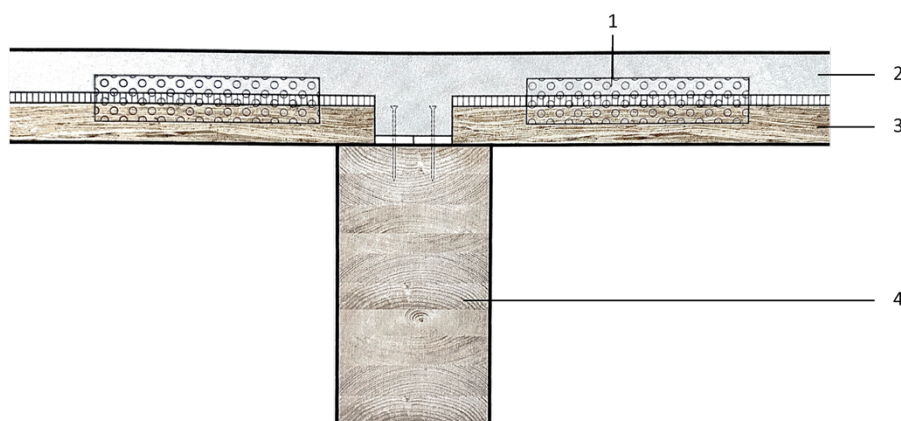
Exemplo esquemático de conexão colaborante entre estruturas de madeira e capa de concreto.
